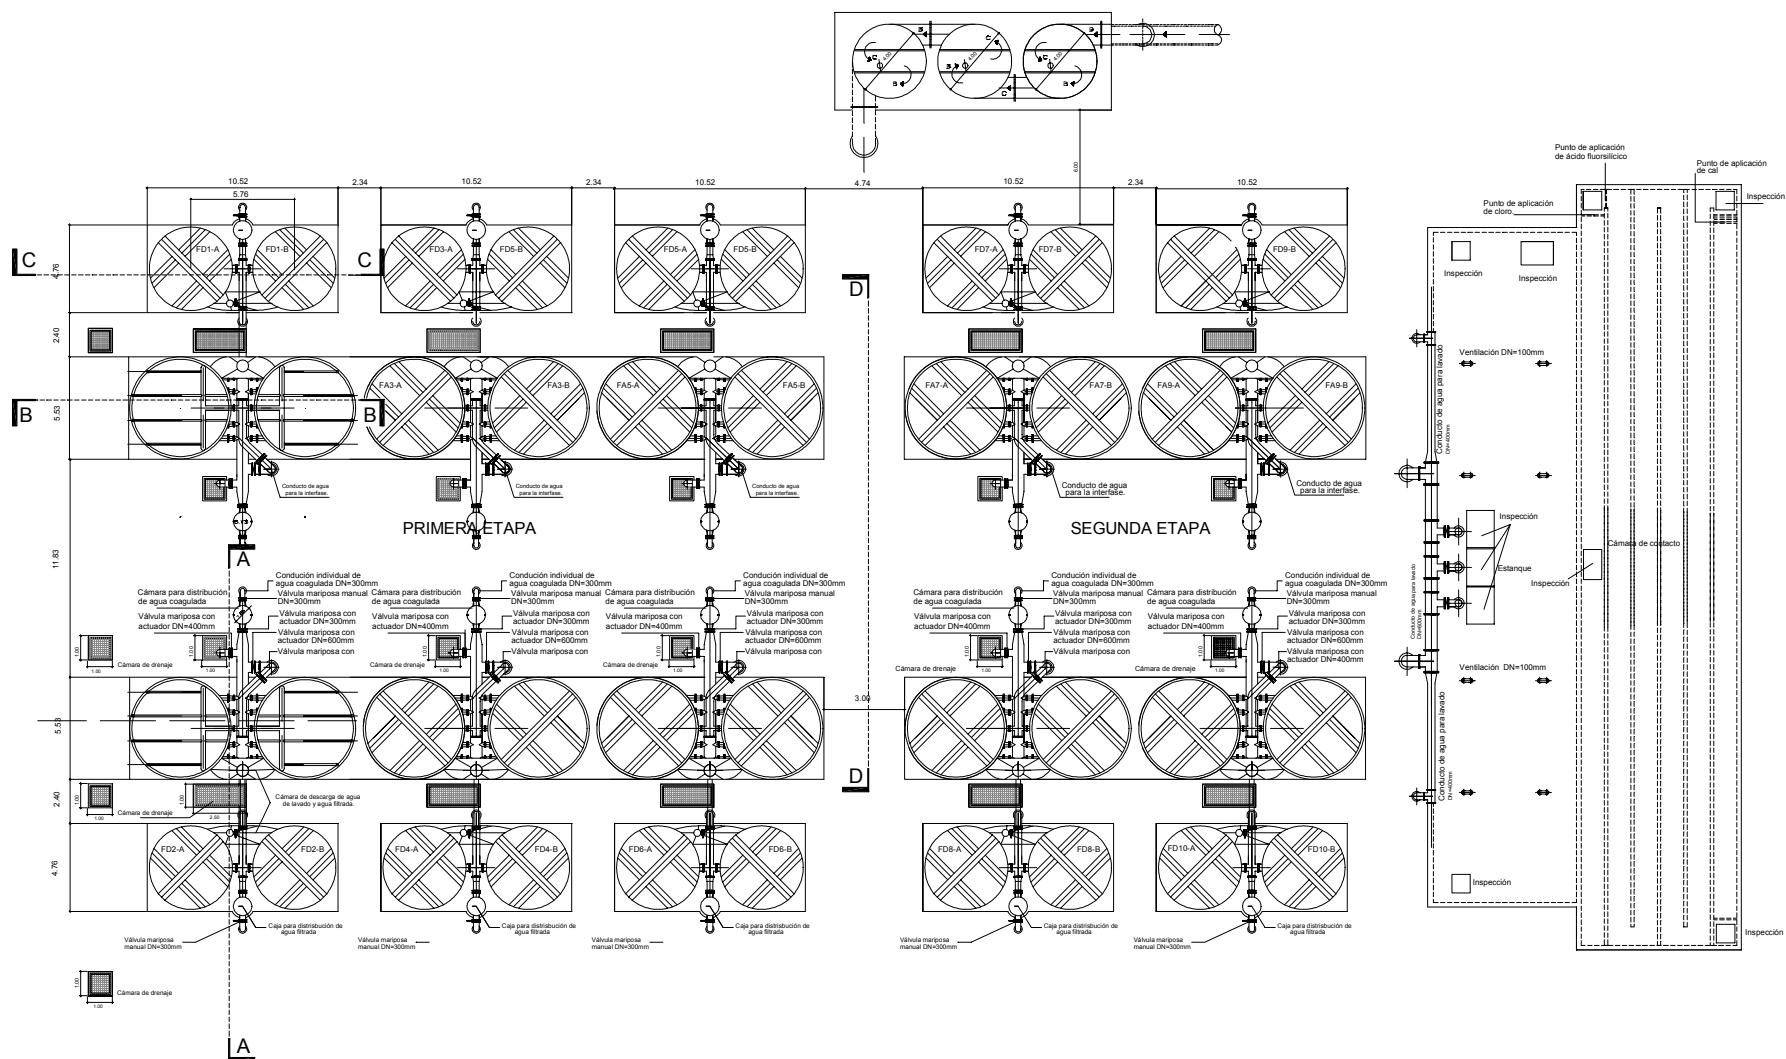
Planta de potabilización con filtros de flujo ascendente – descendente - Planta Superior
